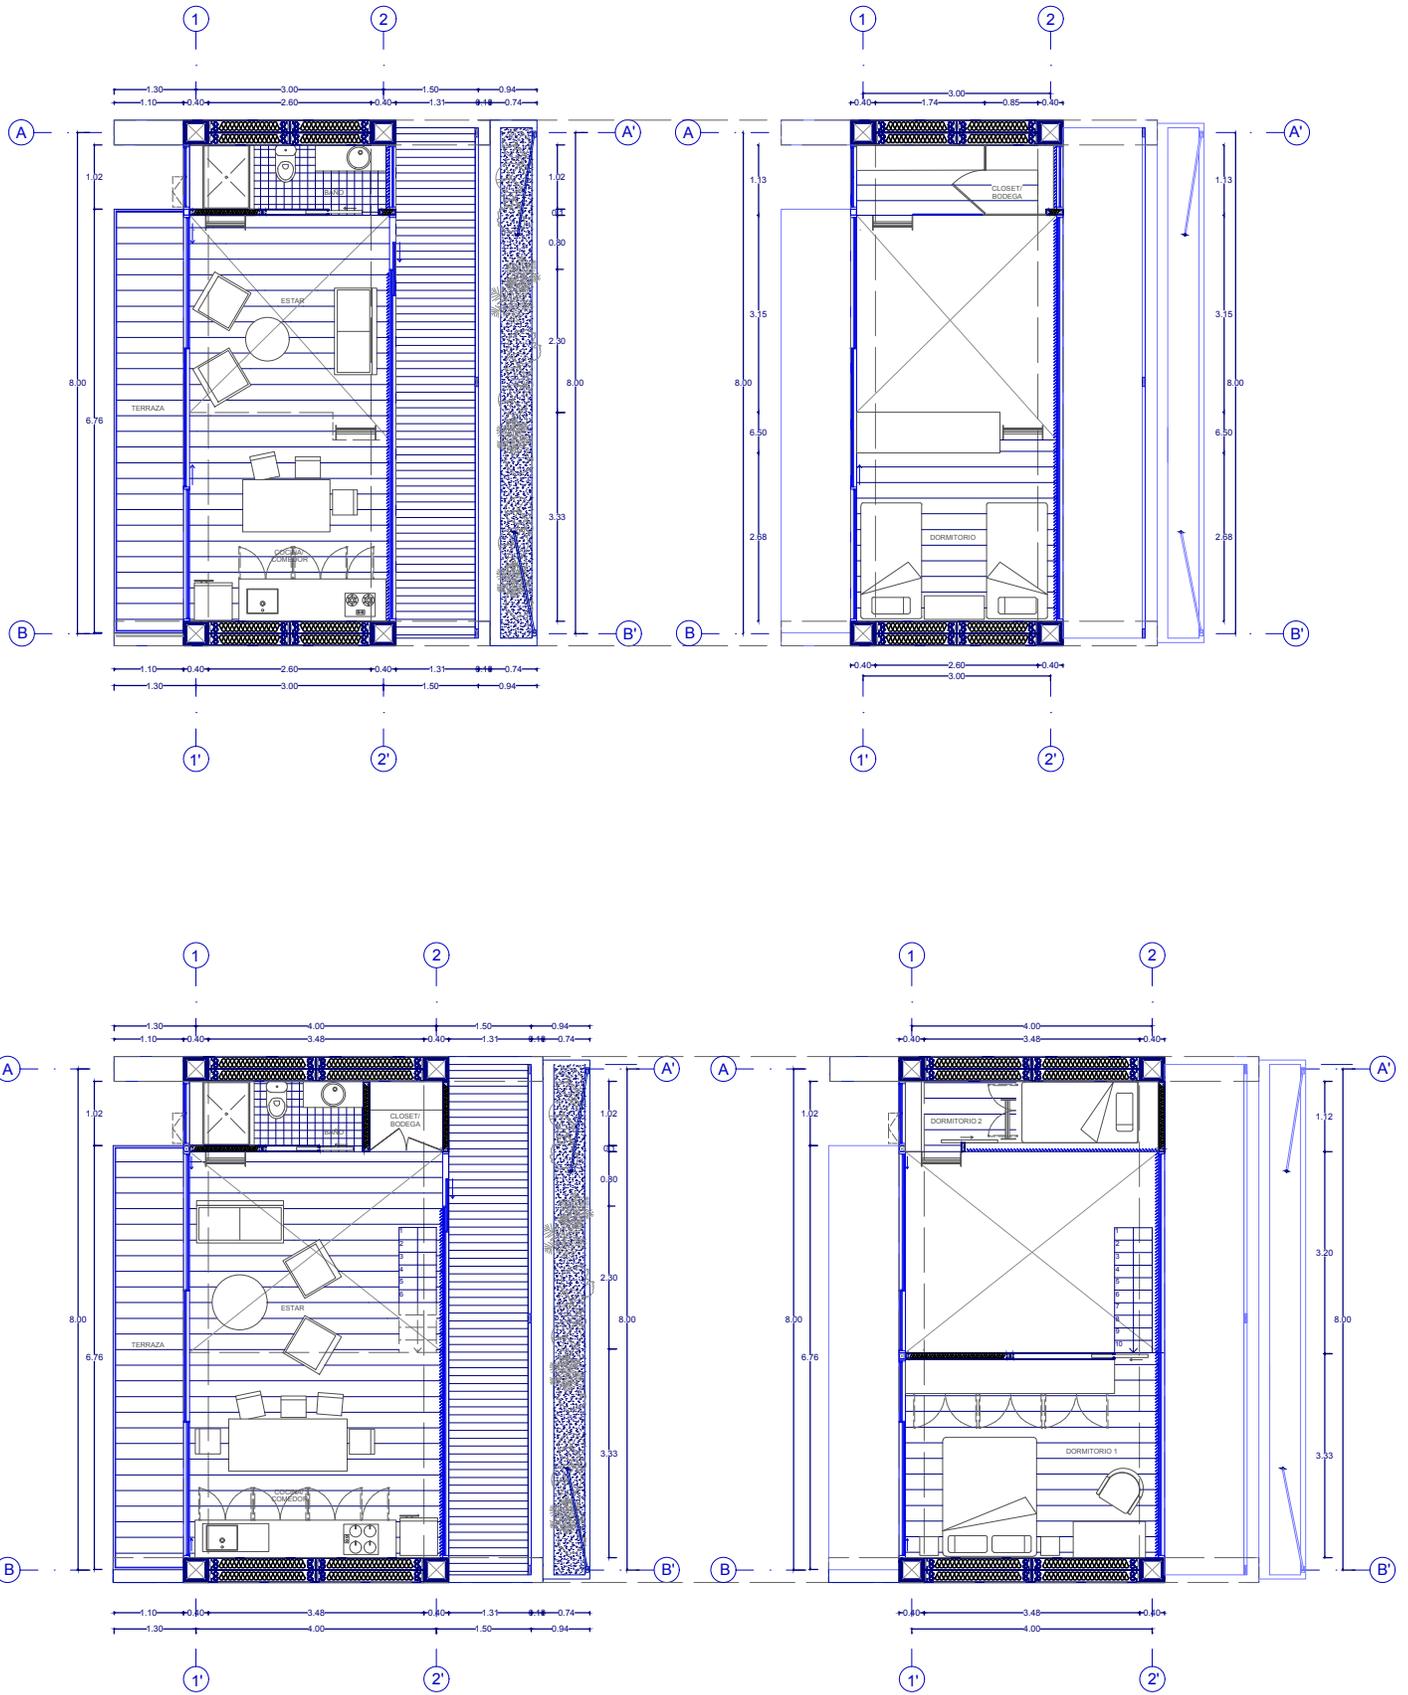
Tipologías de viviendas. Fuente: Elaboración Propia.
